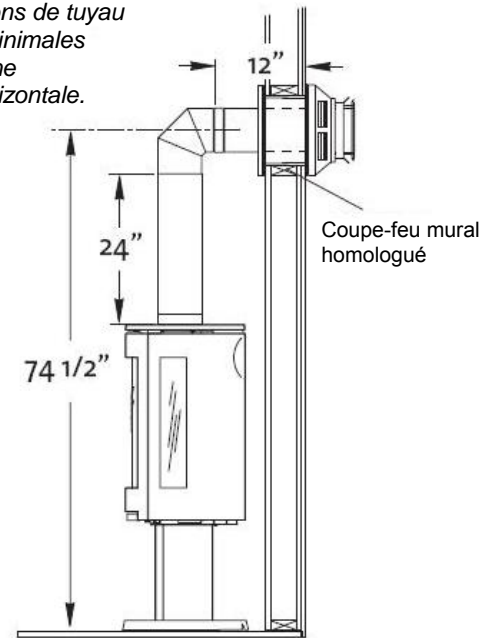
Sections de tuyau de longueurs minimales exigées pour une terminaison avec tuba (*Snorkel*) de 14 po.
